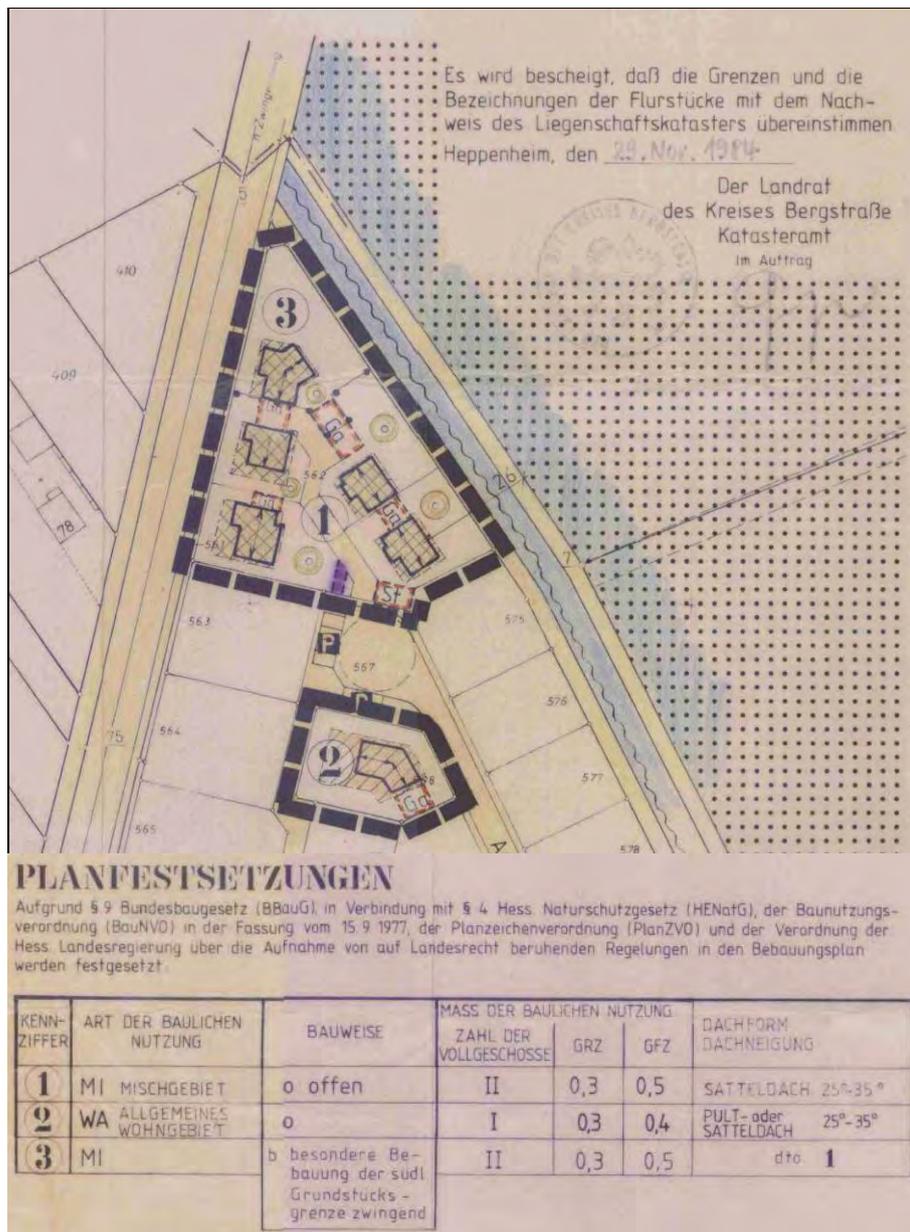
3. Änderung des Bebauungsplans BF 7 "Östlich der Rodauer Straße" (Ausschnitt)
